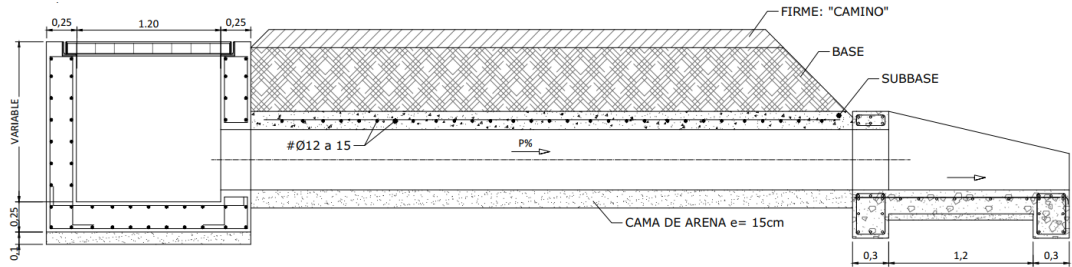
Detalle tipo 1 – Sección A-A'.
